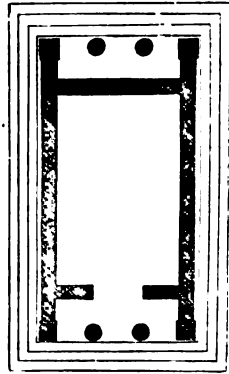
Grundriss eines Anten-Tempels.
